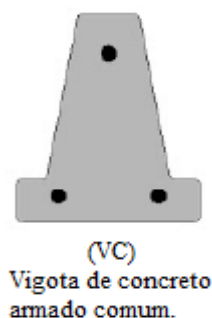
Seção transversal de uma vigota tipo concreto armado.
